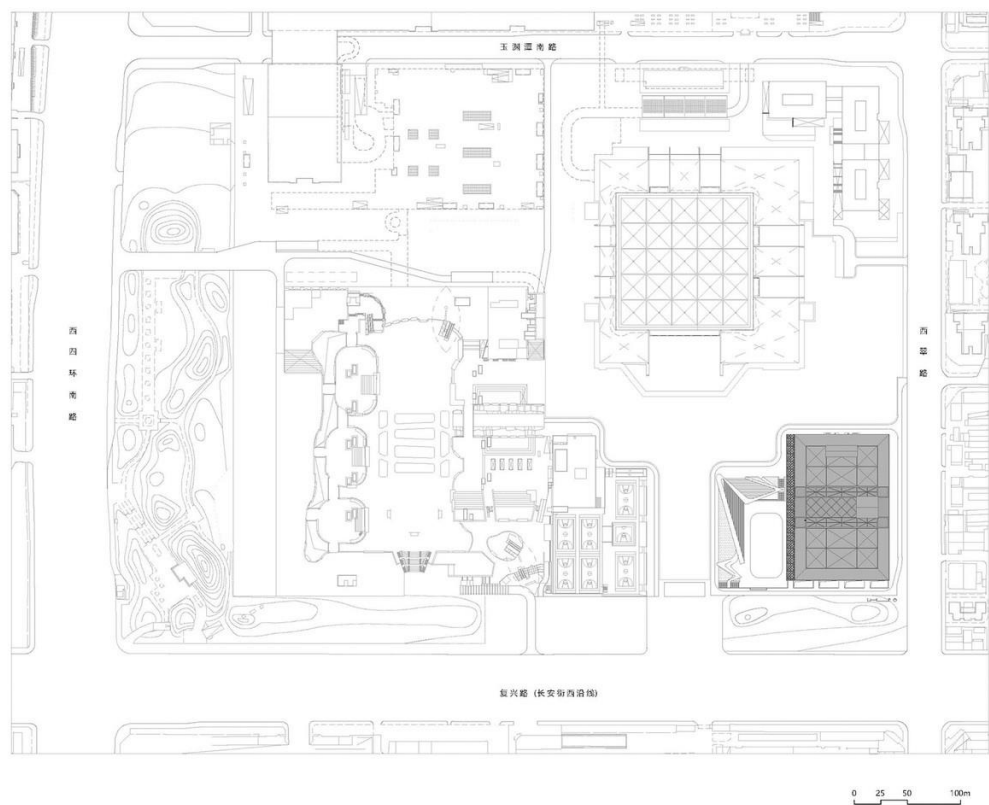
Ситуаційний план, арх BIAD-ZXD ARCHITECTS [1]
